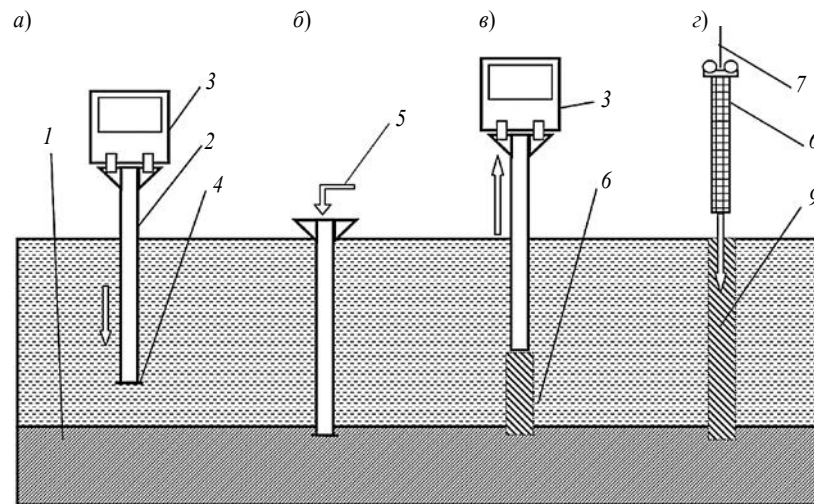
Технологические этапы устройства вибробивной сваи: 1 – плотный грунт; 2 – обсадная труба; 3 – вибропогружатель; 4 – теряемый башмак; 5 – подача бетона бадьей или бетононасосом; 6 – ствол скважины, заполненный бетоном; 7 – вибратор на кране для погружения арматурного каркаса; 8 – арматурный каркас; 9 – свая в грунте
